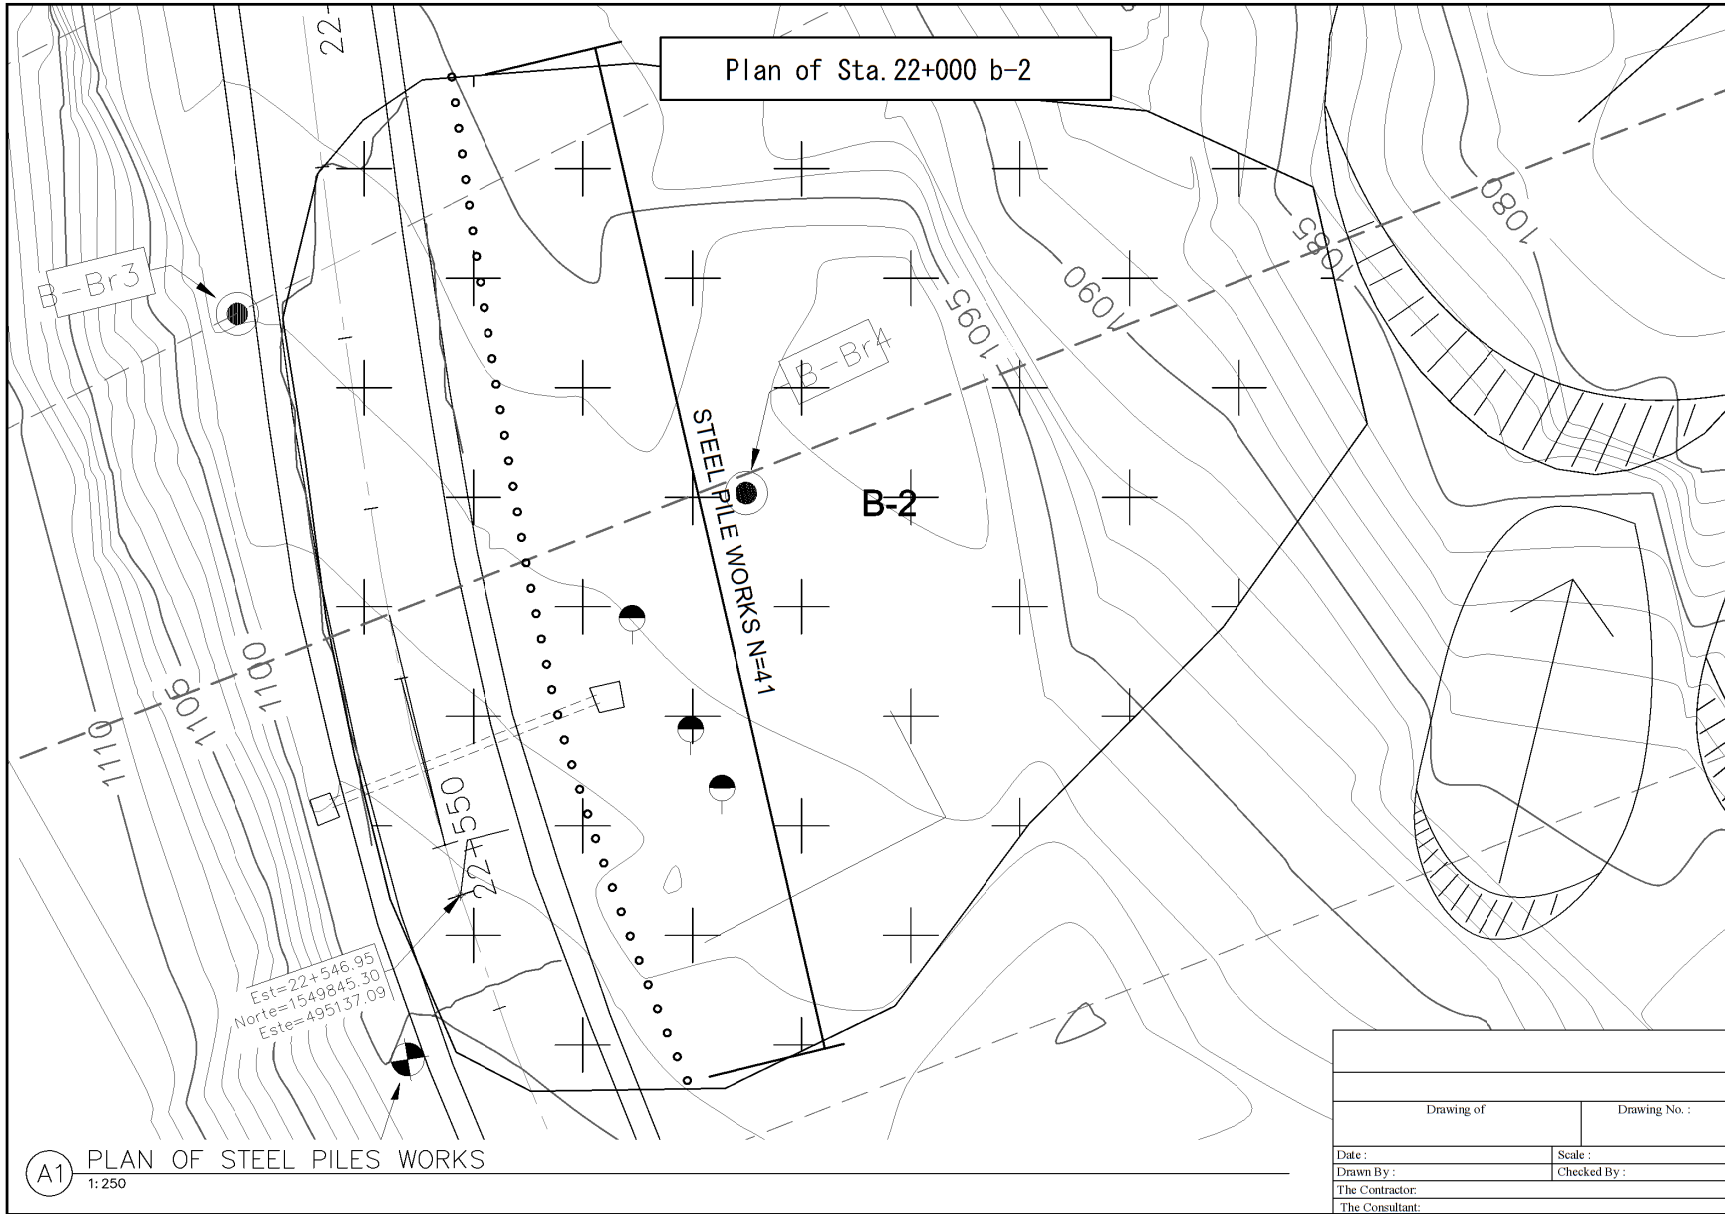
Sta.22 b-2 Vista de plano (Sin escala)
